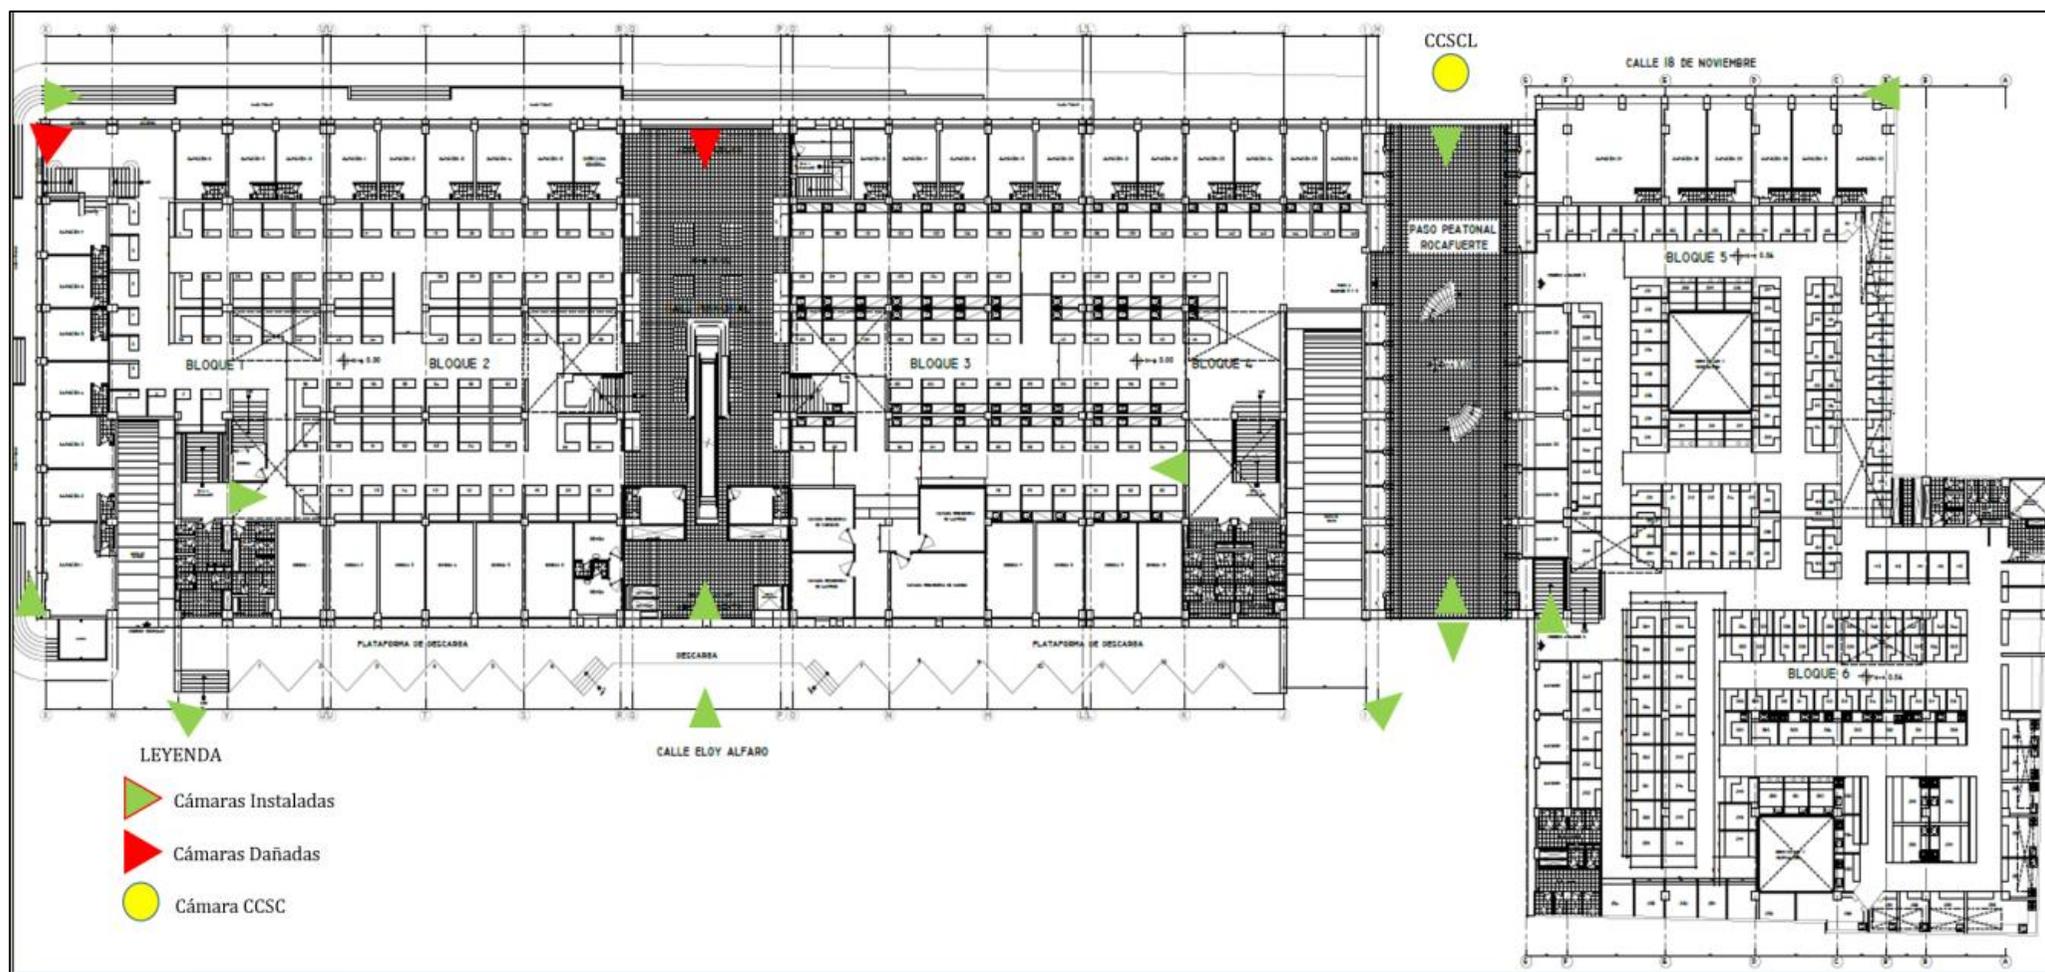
Croquis de cámaras de video vigilancia instaladas en el Mercado Centro Comercial. Planta alta
